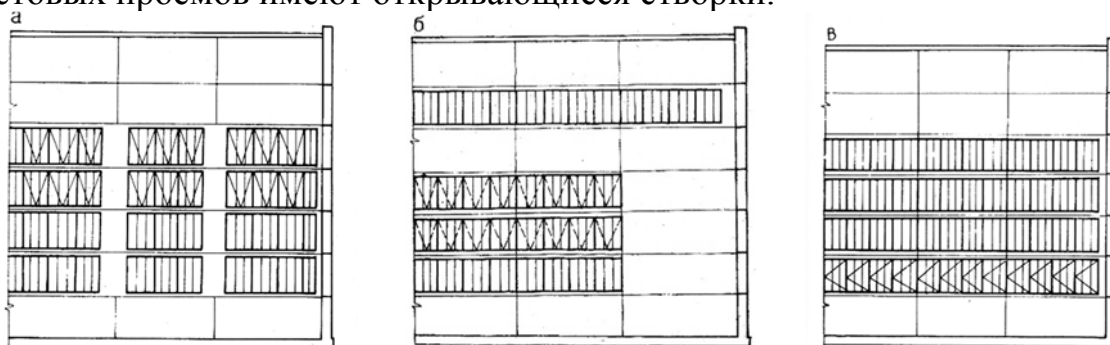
Светопрозрачные ограждения в стенах промышленных зданий [38]:
